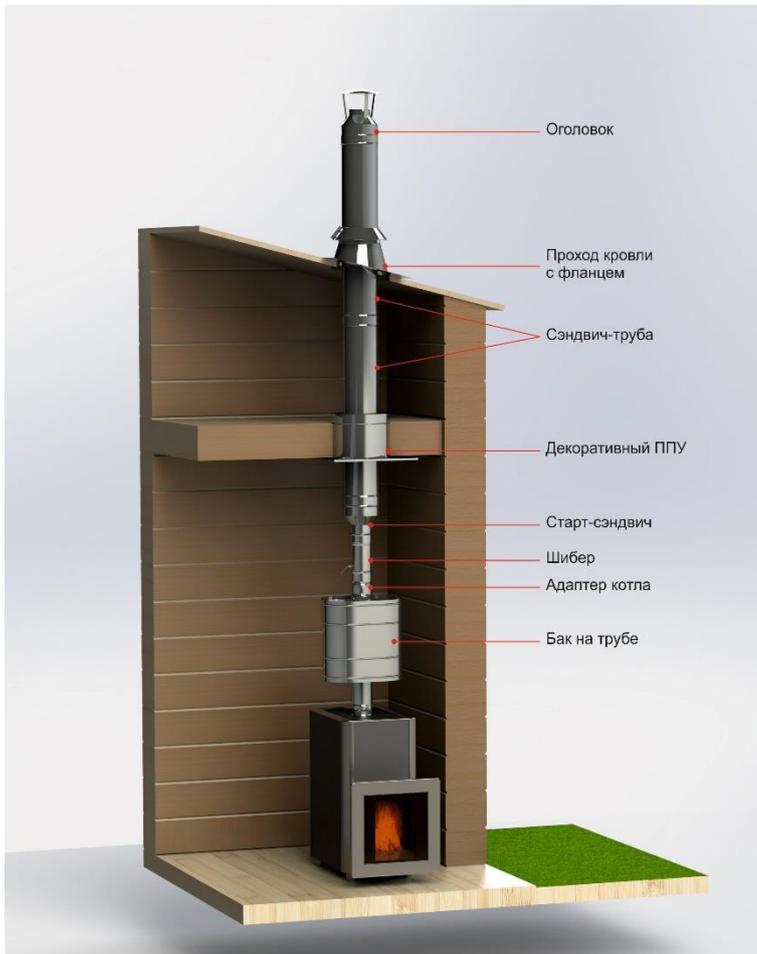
Способ монтажа дымохода на банную печь с баком на трубе.
